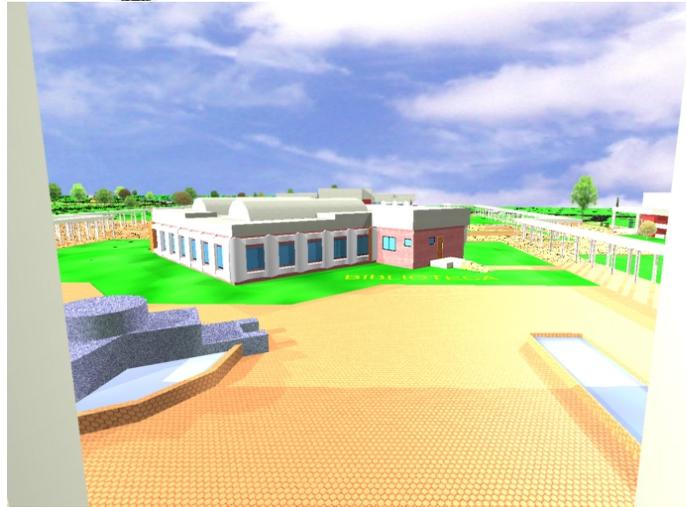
VISTA POSTERIOR DE BIBLIOTECA
